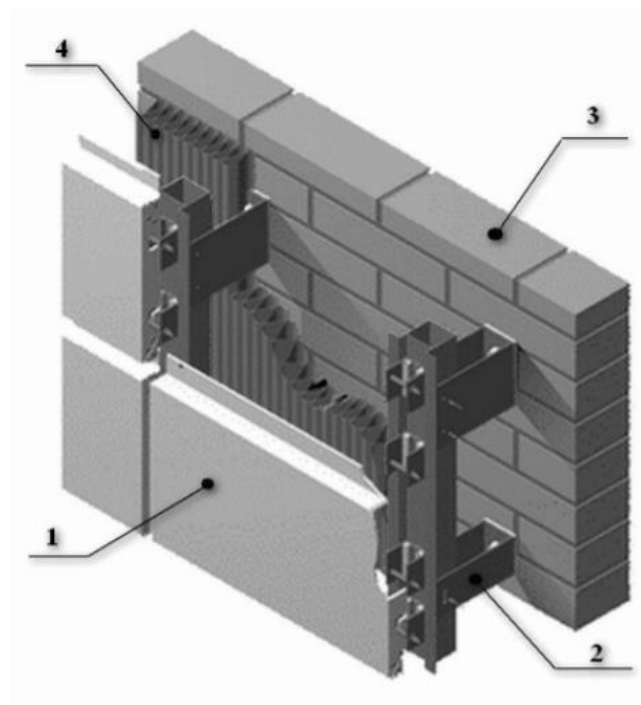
Конструктивна схема навісного вентиляованого фасаду.
